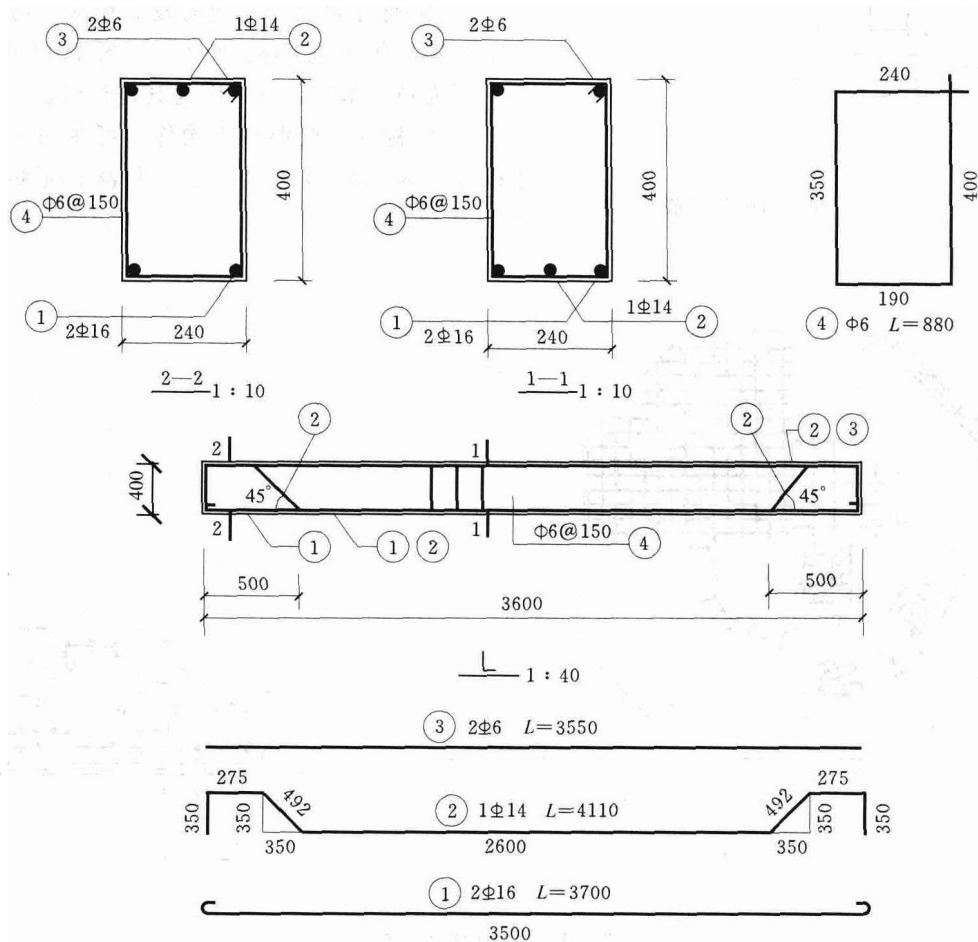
单跨简支梁的配筋立面图和配筋断面图
